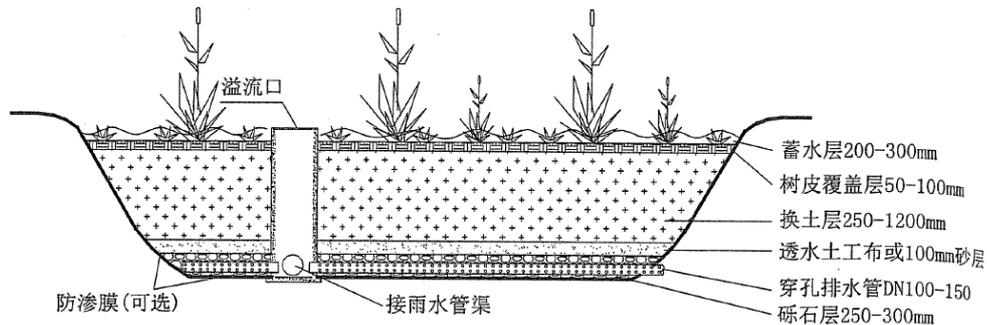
复杂型生物滞留设施典型构造示意图
